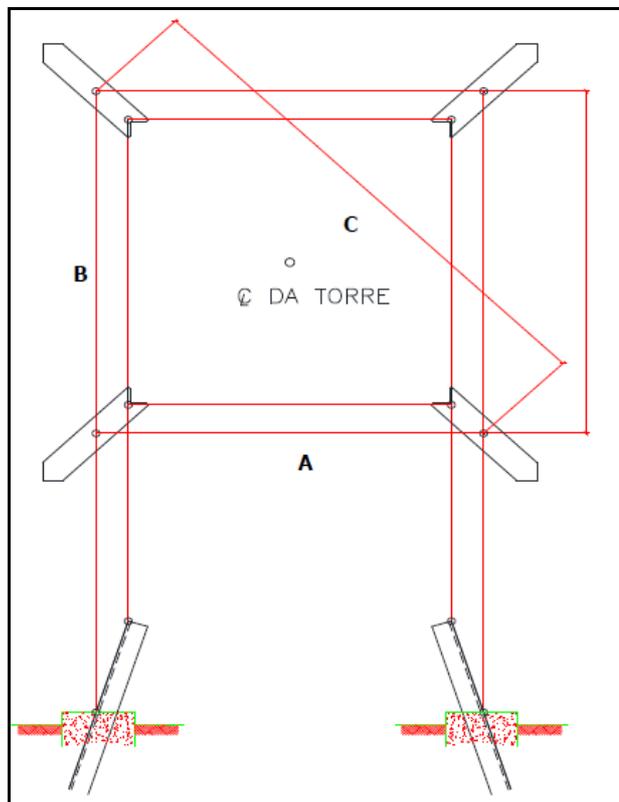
Croqui para locação da torre autoportante da LT 500 kV Manaus - Boa Vista e Subestações Associadas
